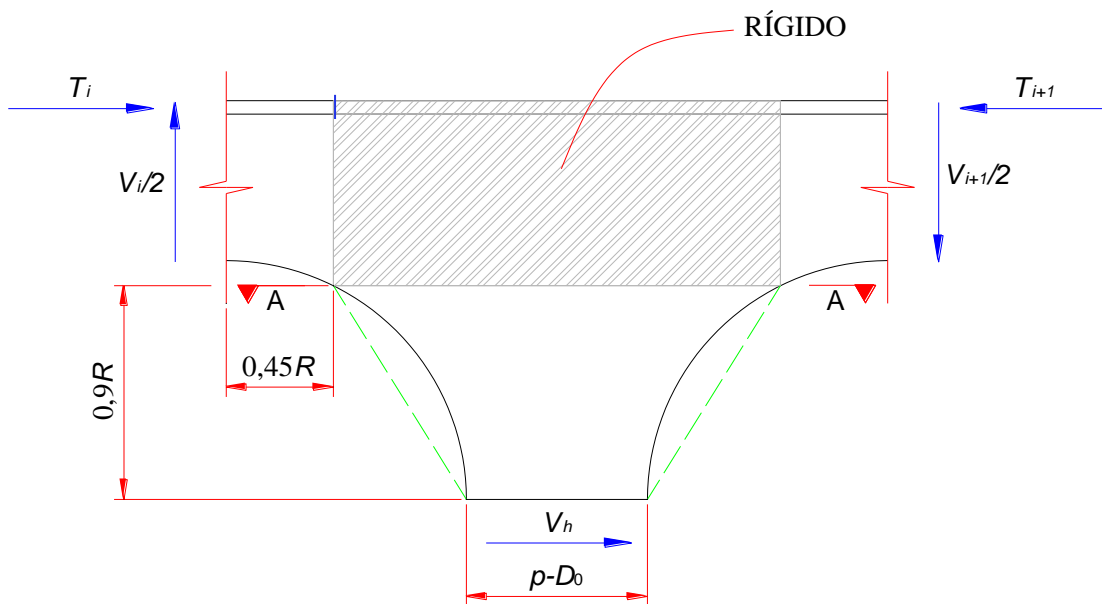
Forças aplicadas e seção crítica no montante de alma de uma viga castelada hexagonal equivalente (adaptado de Ward, 1990).
